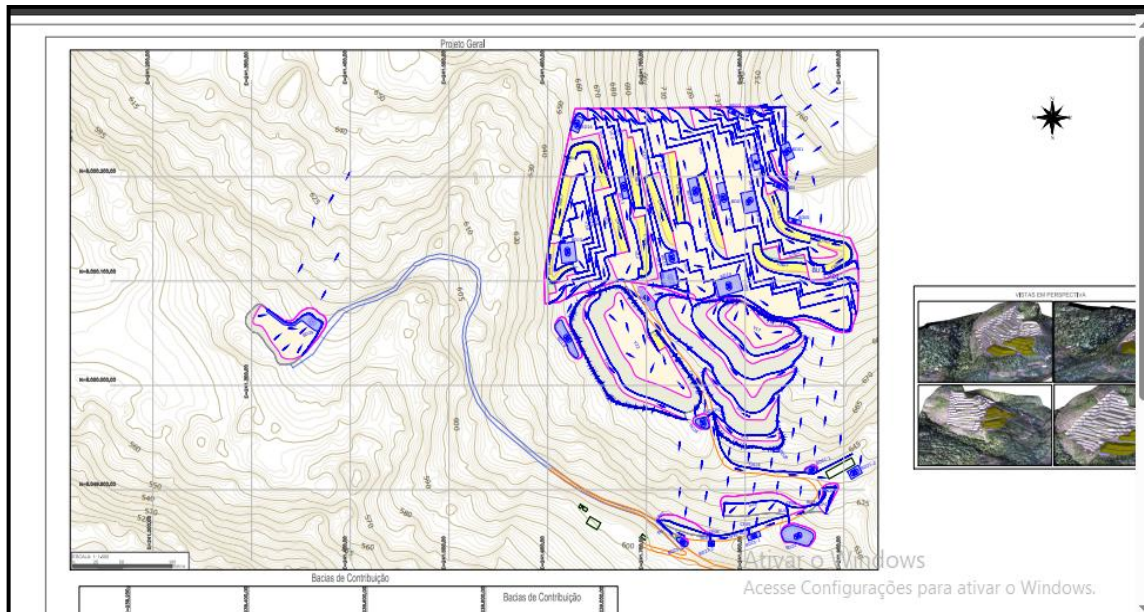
Layout do Sistema de Drenagem. Fonte: Autos do PA SLA 267/2025.
